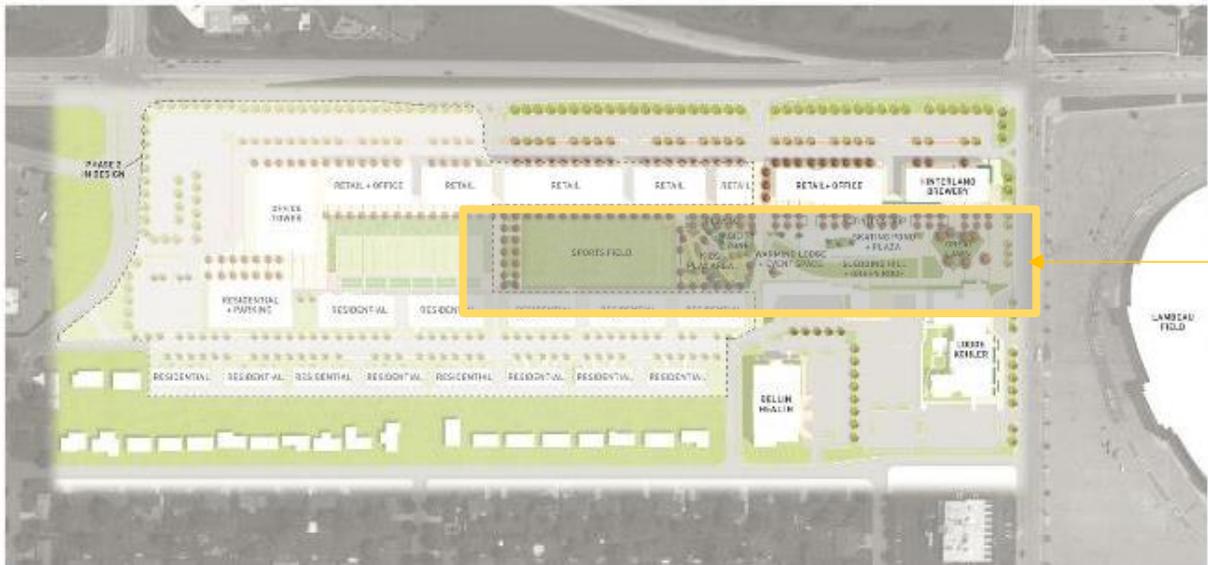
Fotografía satelital con plano de conjunto del Plan Maestro Green Bay. Green Bay Packers Titletown District Sledding Hill
